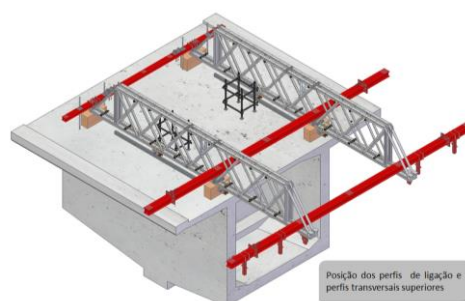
Posicionamento de perfis de ligação transversais superiores
